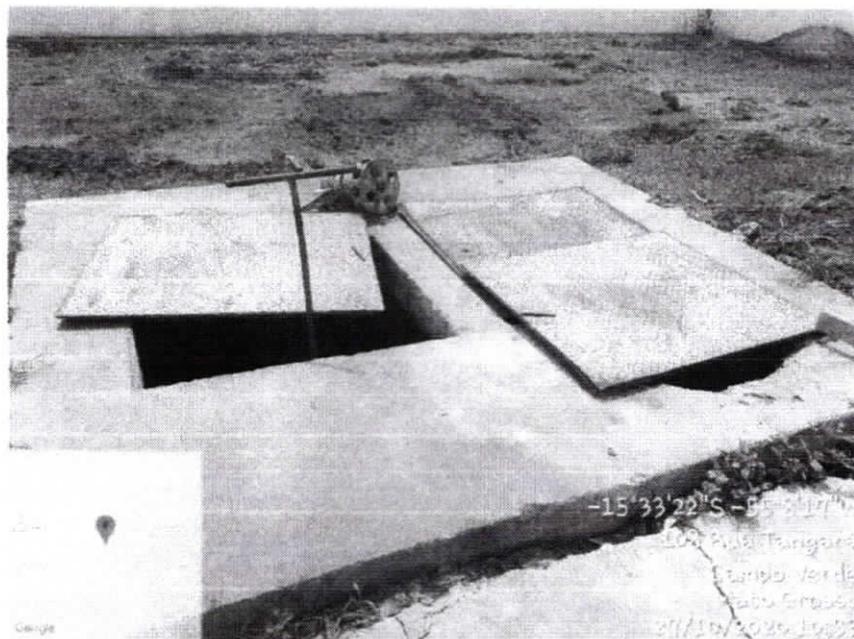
Detalhe de poços da elevatória com tampas desencaixadas e sem grades de proteção.
